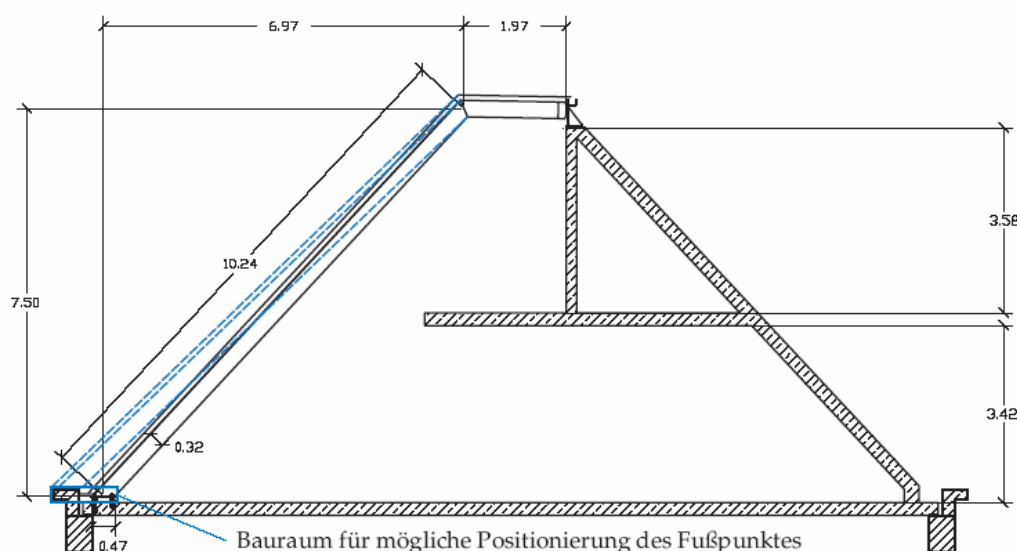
Alternative Dachkonstruktion aus geschweißten Aluminium- bzw. Stahlsparren
